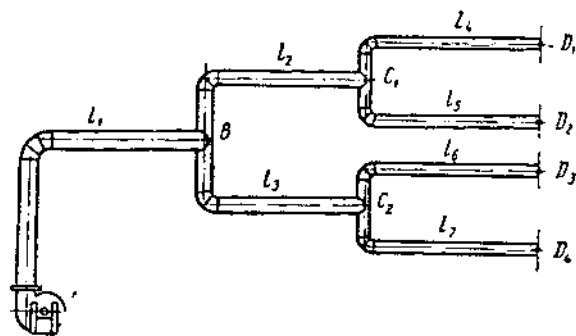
Схема трубопровода с параллельным движением газовых потоков
